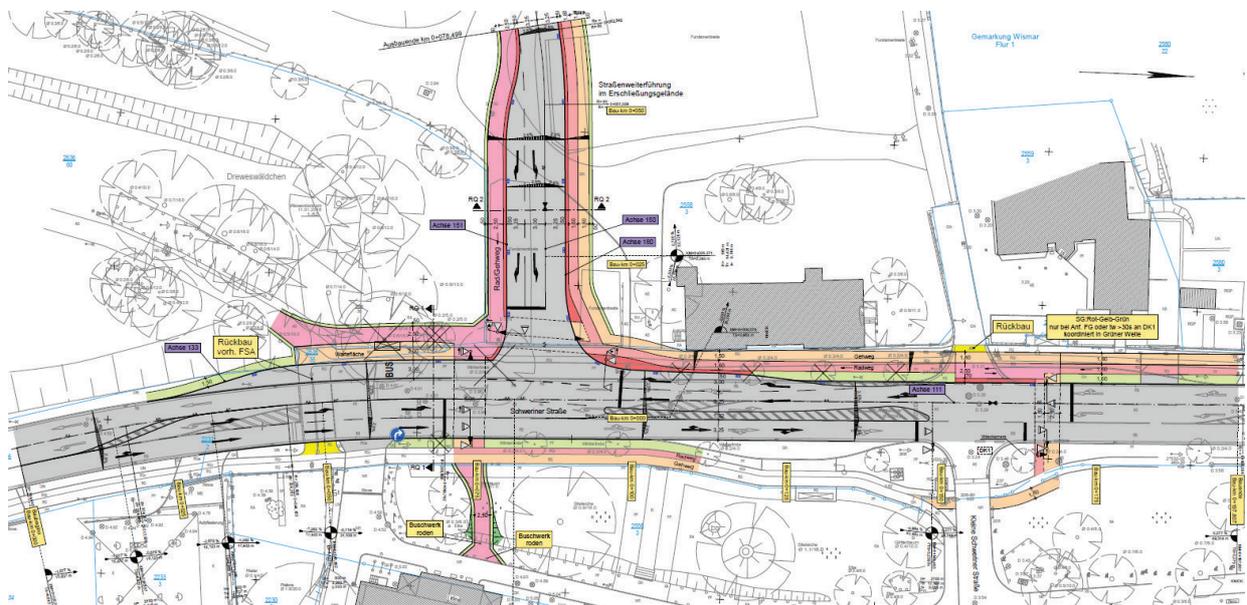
Erschließungsplanung Schweriner Straße mit Anbindung an Plangebiet. Quelle: Ingenieurbüro Klaeser; Waren (Müritz); Stand: November 2019
